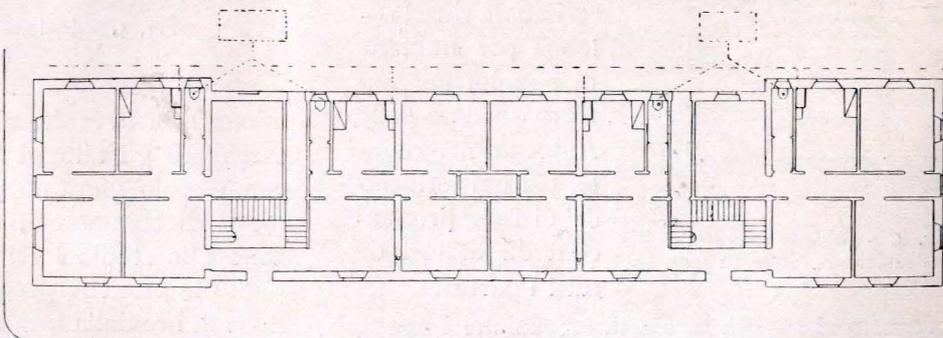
Piano terreno dell'edificio B (scala 1 : 400).
